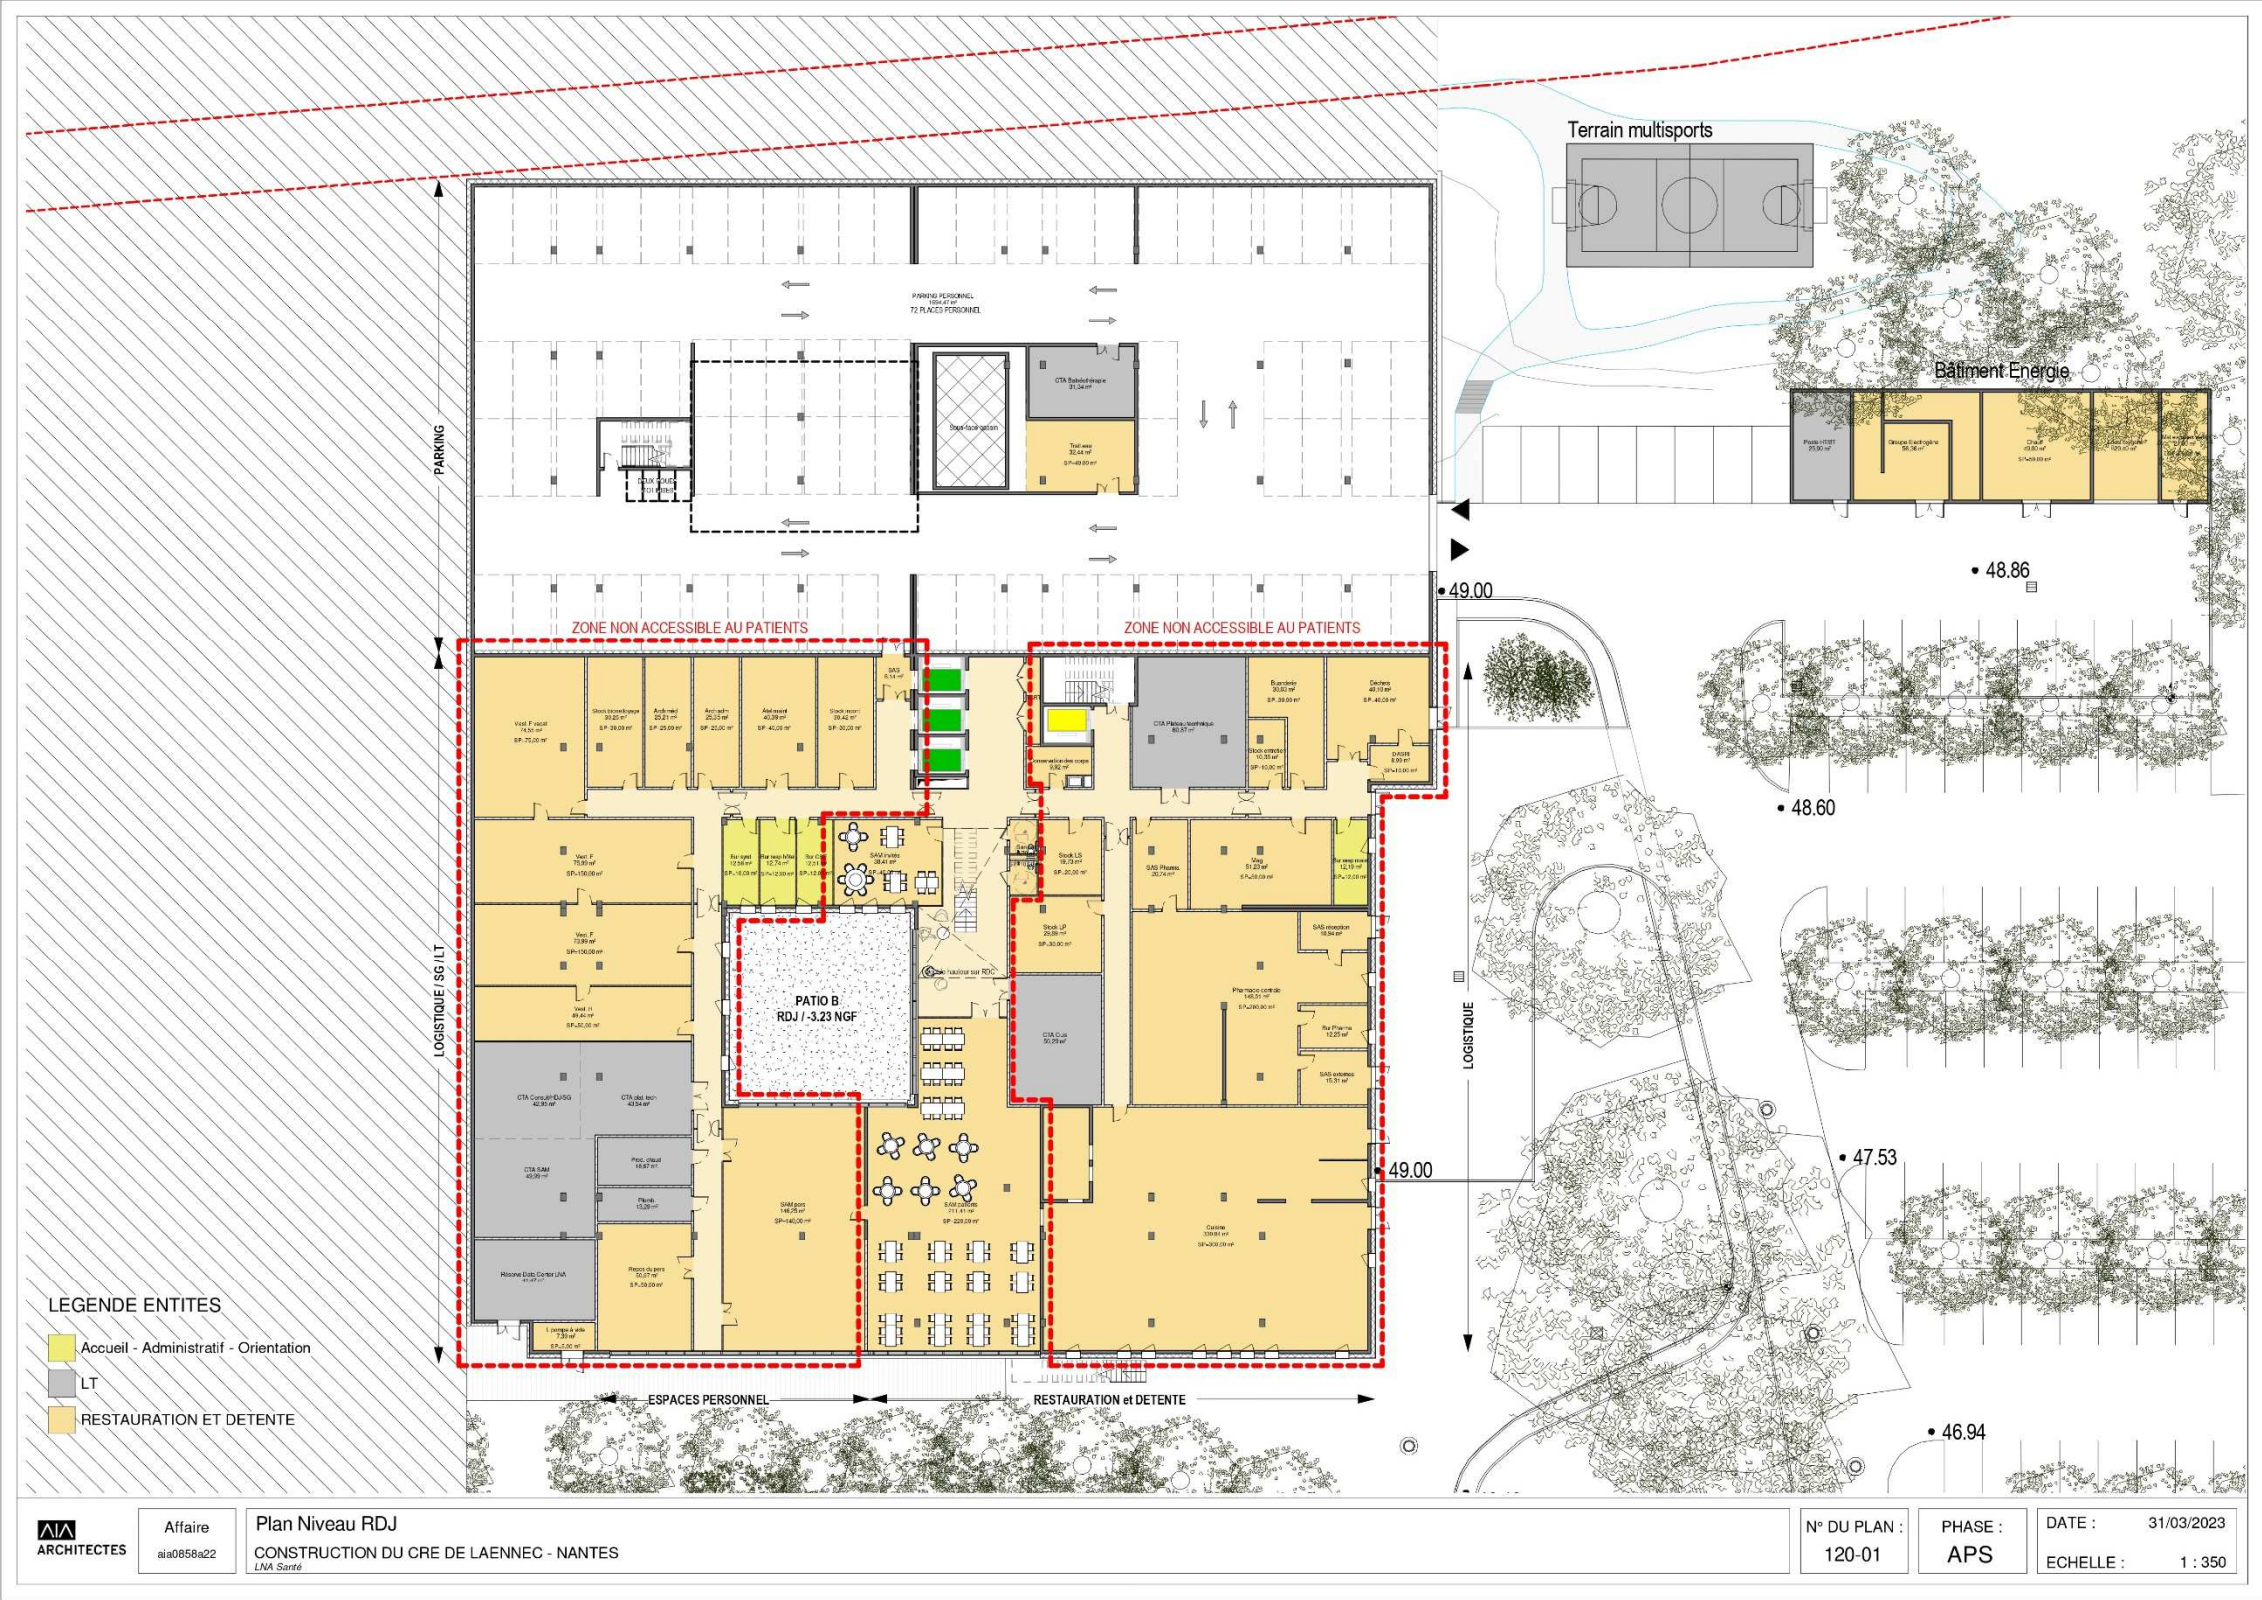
Plan de rez-de-jardin (source: AIA Architectes,31/03/2023)
